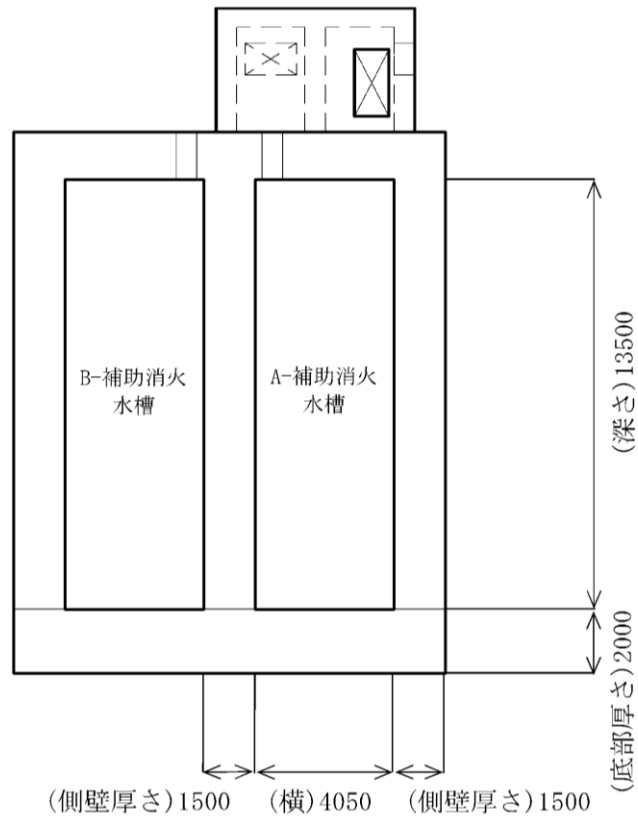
(1) 補助消火水槽 断面図 (A-A 断面)
